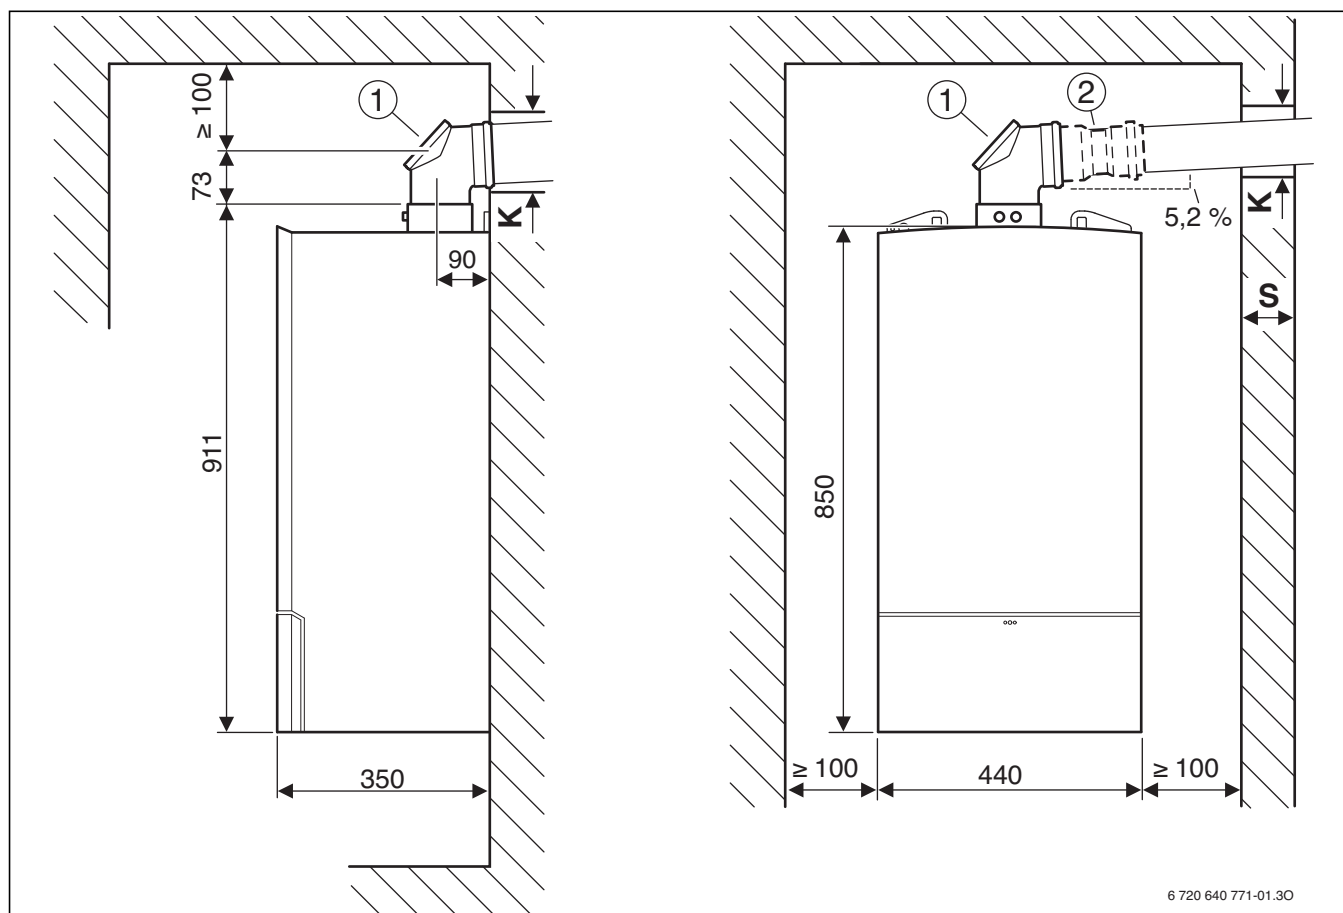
Abgasführung Ø 80/125 mm, Ø 80 mm oder Ø 60/100 mm
